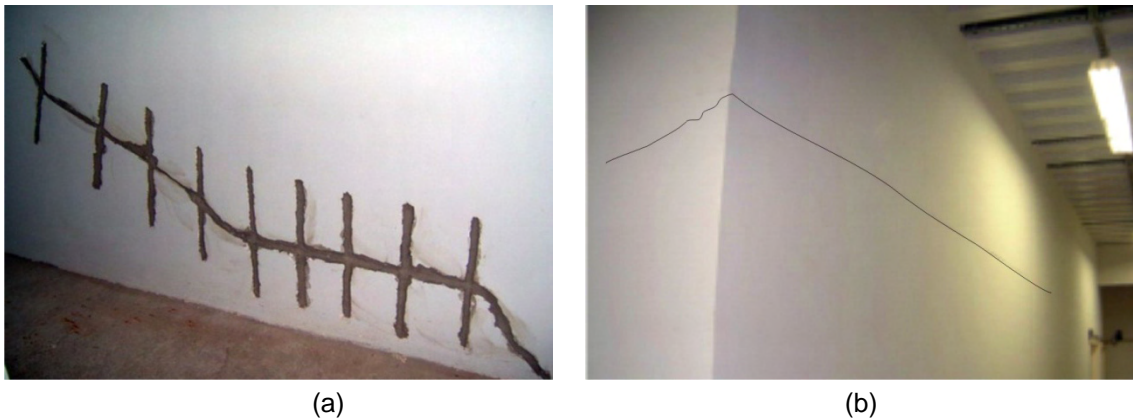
Fissuras nas paredes internas do edifício.
